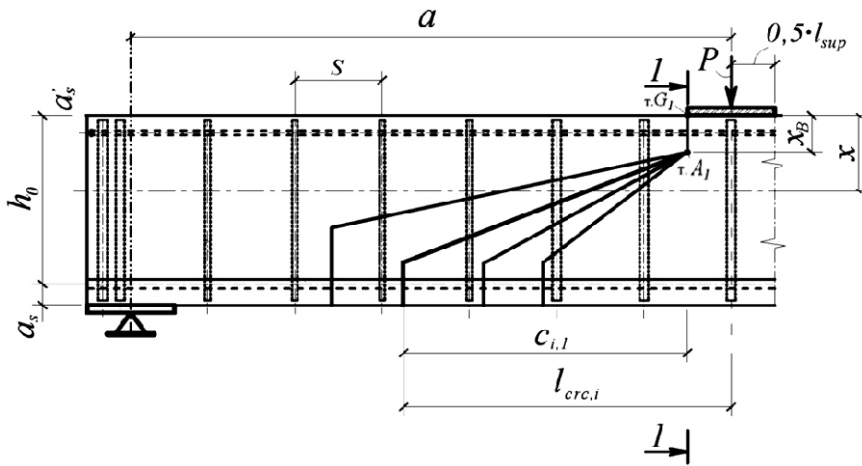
Расчетная схема для определения параметров напряженно-деформированного состояния железобетонных конструкций в зоне трещин, образующих веер 1, прилегающий к сосредоточенной силе (стадия, соответствующая определению ширины раскрытия трещин)
